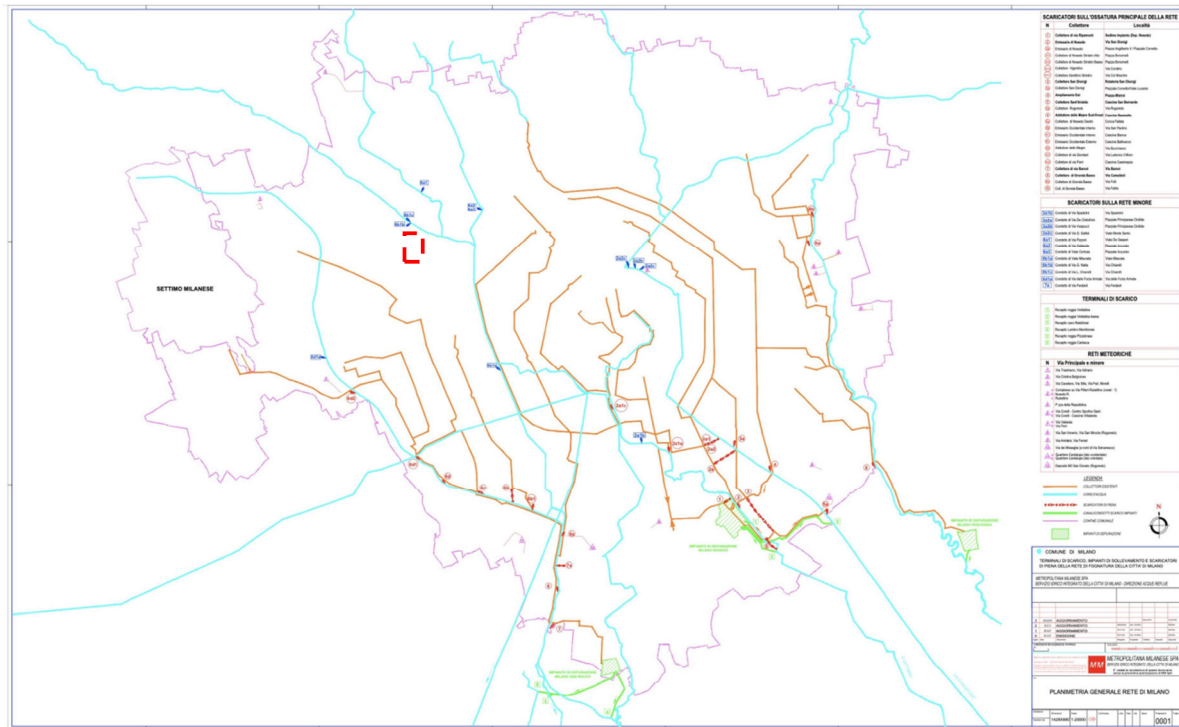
Planimetria rete fognaria – Ambito MM
